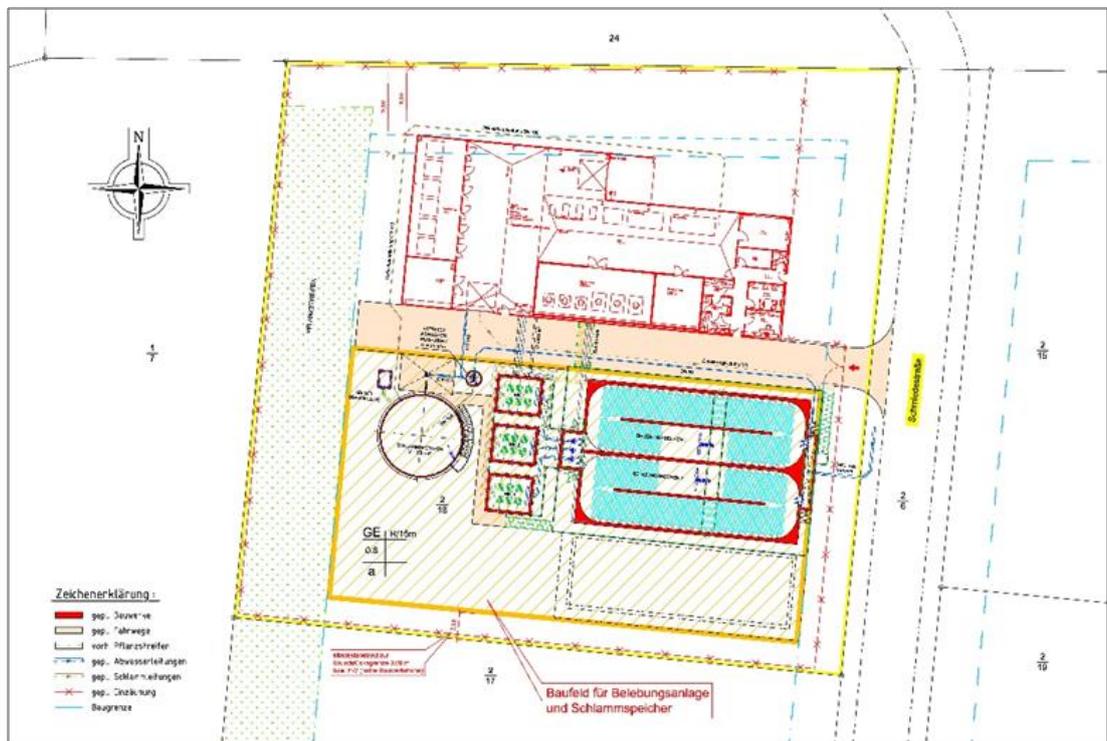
Auszug aus Lageplan mit geplanten Bauwerken
